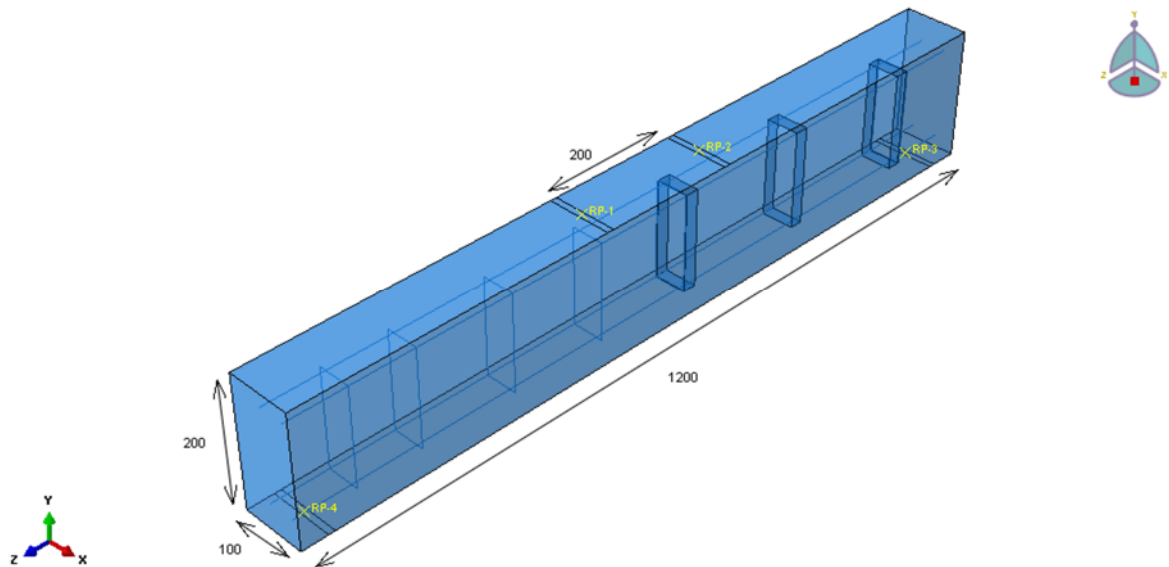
Poutre en béton armé soumise à la flexion quatre points
